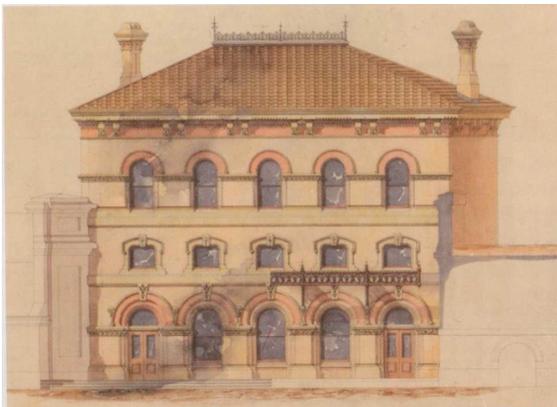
, Stazione di Battersea Park, prospetto principale, 1866
